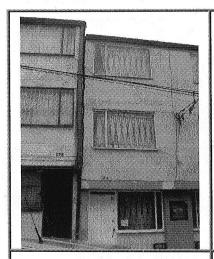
Separación de la última casa de la manzana de la zona C-3.
